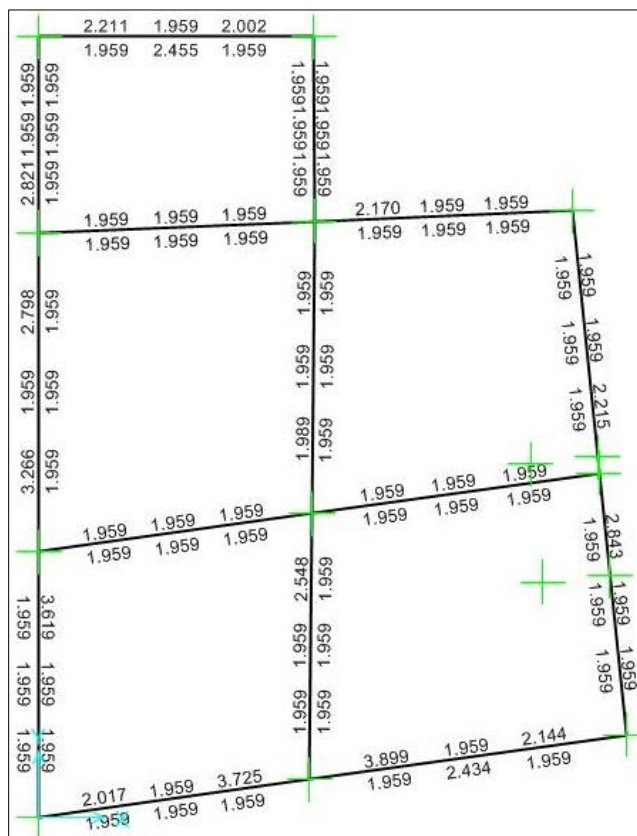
Armadura longitudinal nas vigas de fundação
